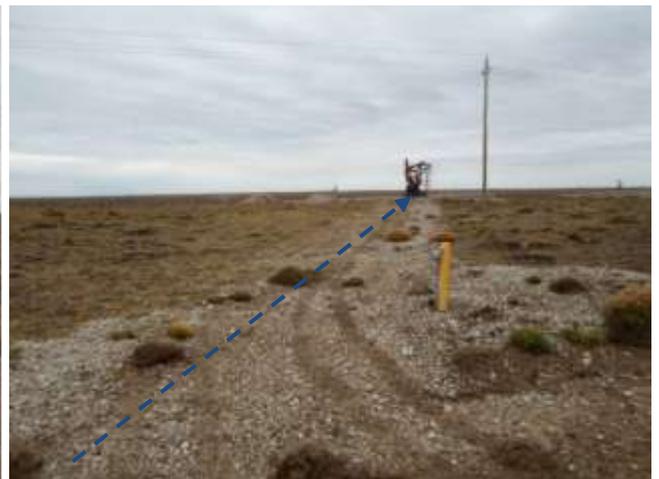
Emplazamiento por picada existente previo al ingreso a la locación del pozo. Foto en dirección O.
